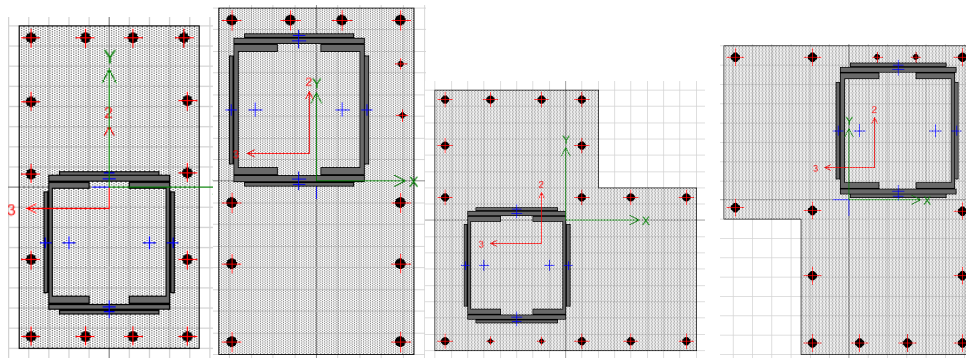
Columna Tipo 1, 2, 3 y 4 en Capilla
